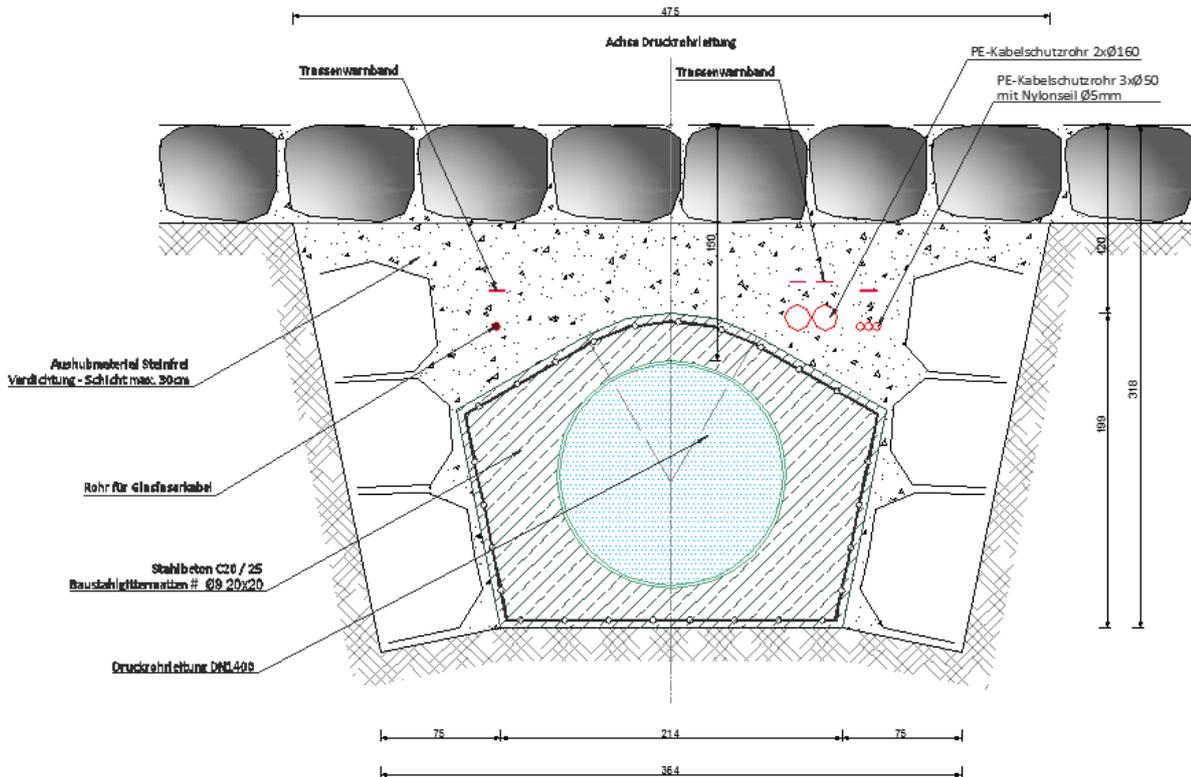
Sezione tipo di posa della condotta DN 1400 in attraversamento
